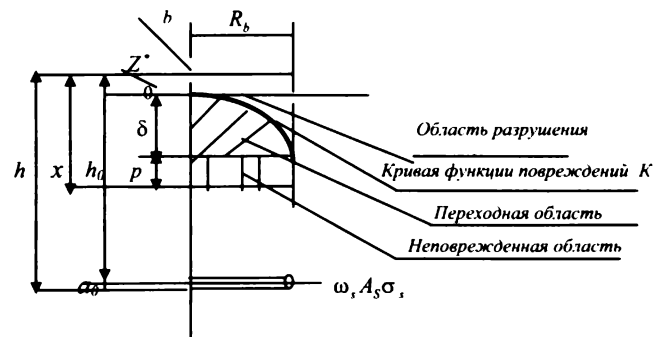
Схема силового сопротивления поперечного сечения изгибаемой железобетонной балки с одиночной арматурой
